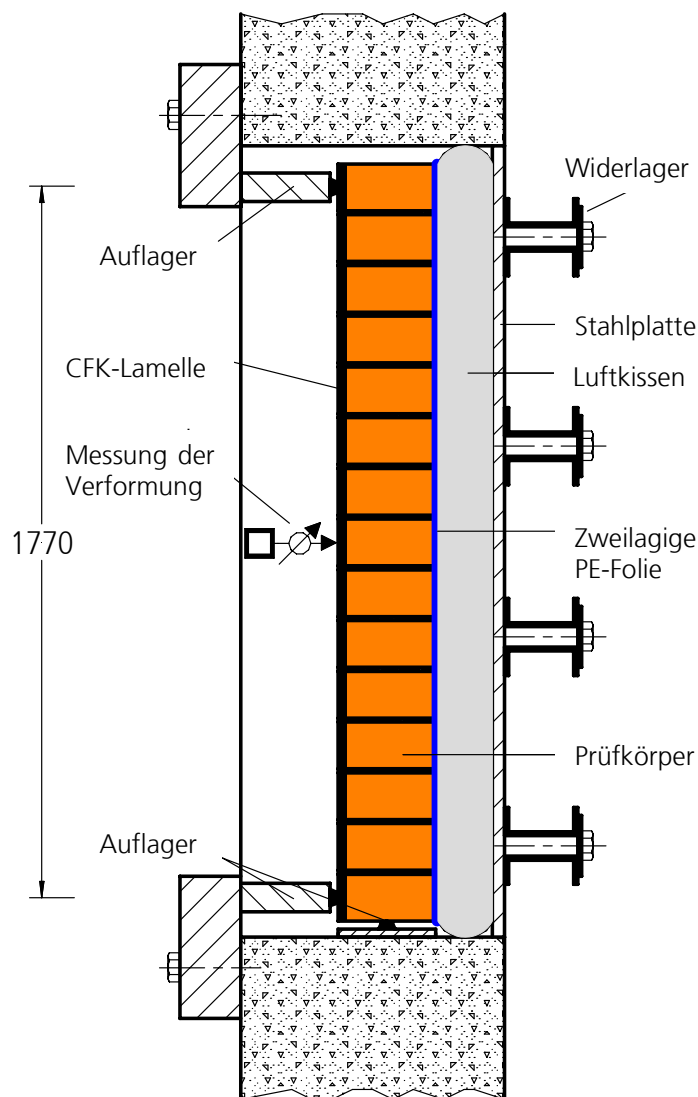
Versuchsaufbau und Prüfeinrichtung zur vollflächig statischen Belastung der Prüfkörper mit einem Luftkissen.
